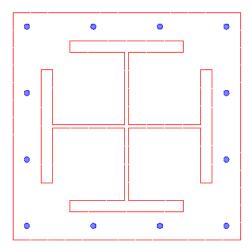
Сечение с жесткой арматурой, образованной из тавров
